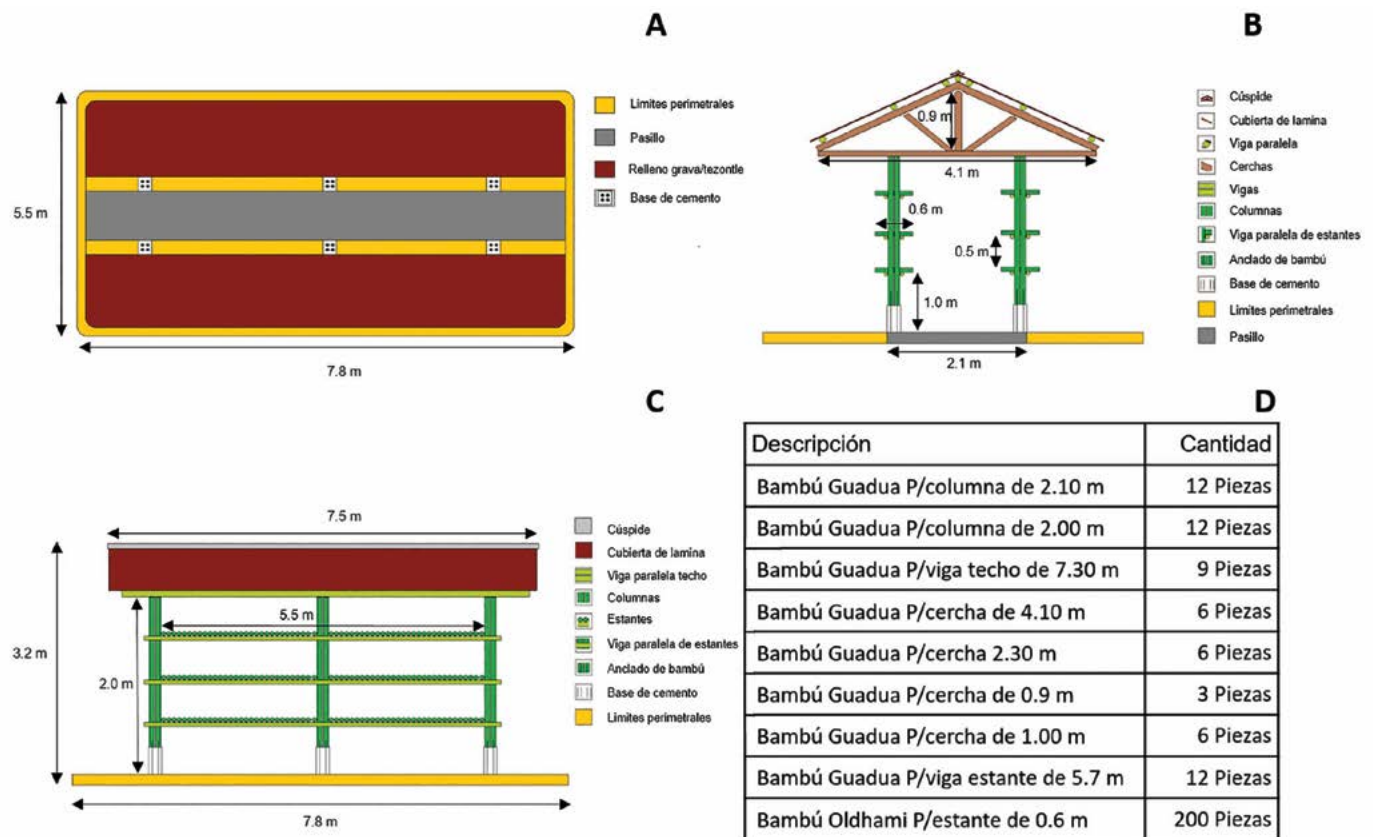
A: Vista aérea de piso. B: Vista lateral de piso, estructura de soporte tipo Pratt, cubierta del techo, columnas y estantes. C: Vista frontal de piso, columnas, estantes y techo. D: Longitud de las piezas de bambú para estructura de soporte tipo Pratt y estantes.
